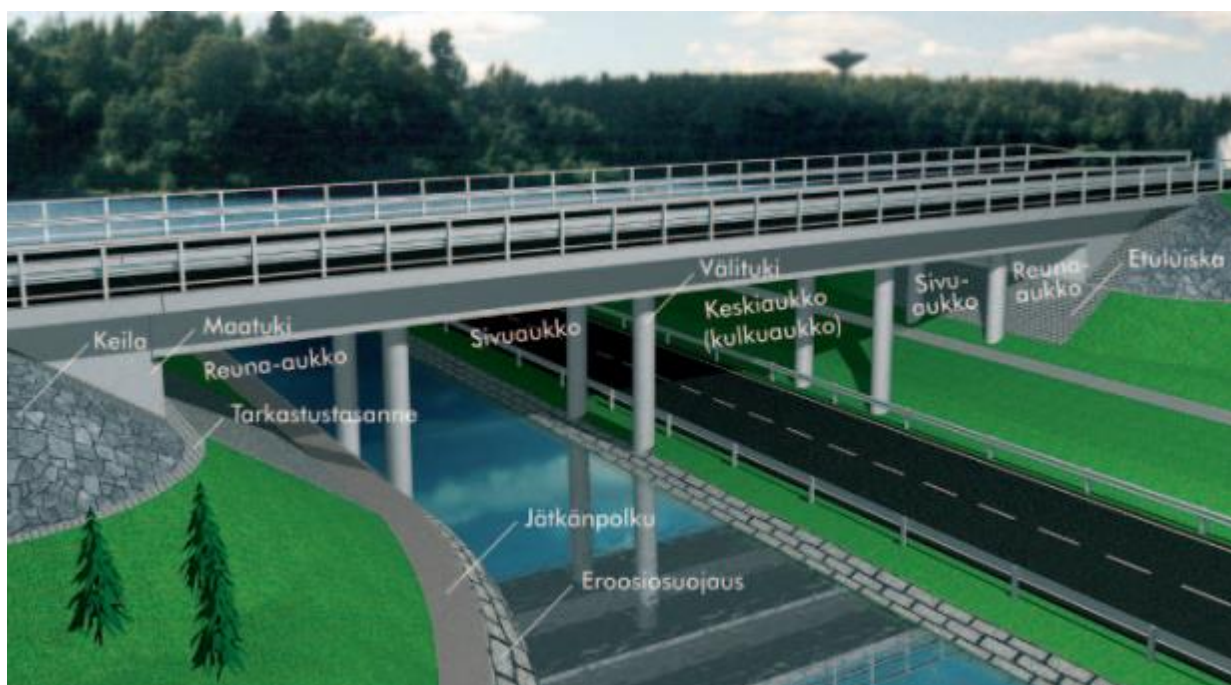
En animerad betongbro och dennes enskilda konstruktionsdelar. (Tiehallinto 2004)
